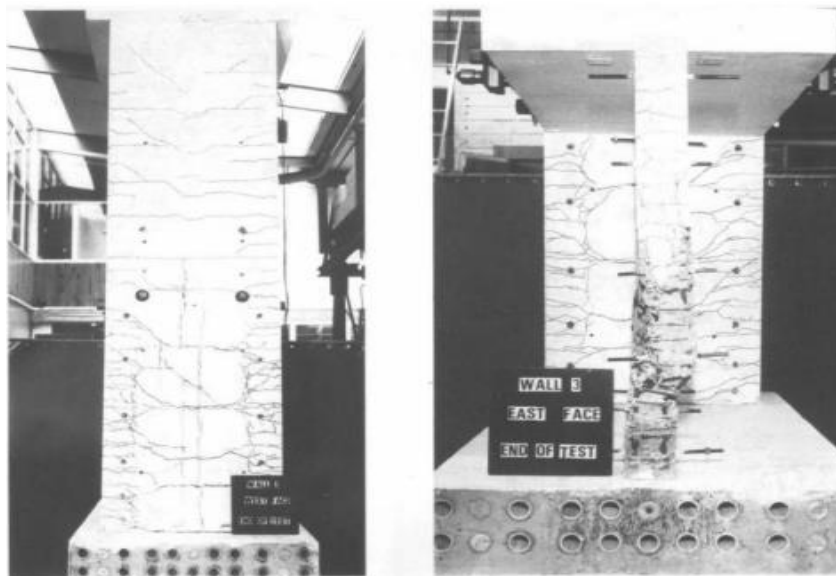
Muro al final del ensayo. Vistas de las caras este y oeste
